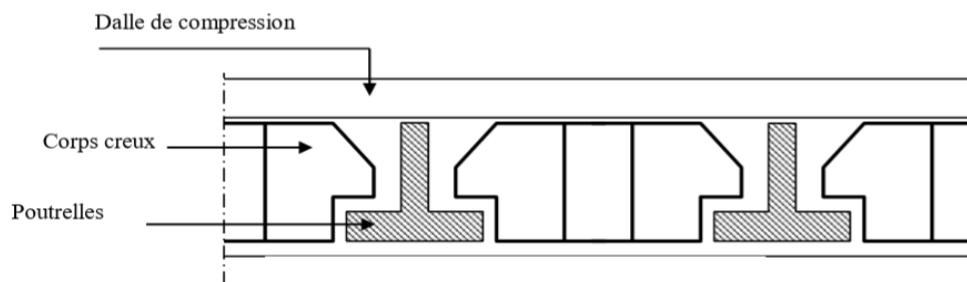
Coupe transversale d'un plancher à corps creux.
